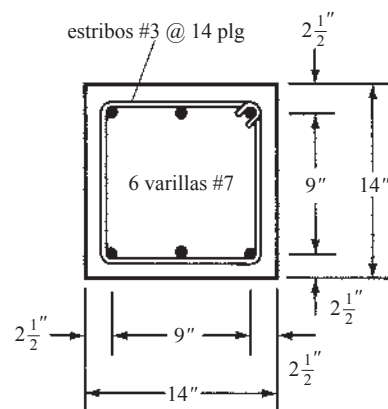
Sección transversal final de la columna del Ejemplo 9.1.
